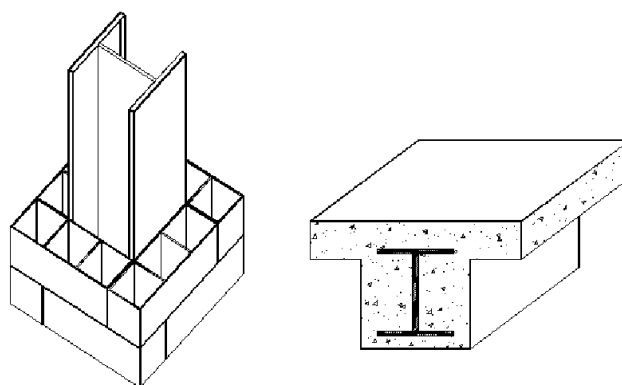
Proteção de pilares e vigas com utilização de alvenaria e concreto
